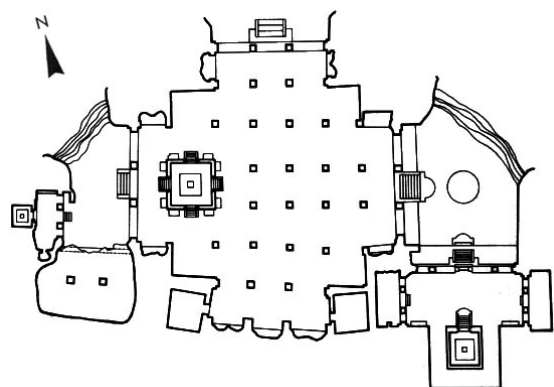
Grundriss Śiva-Heiligtum/Elephanta
